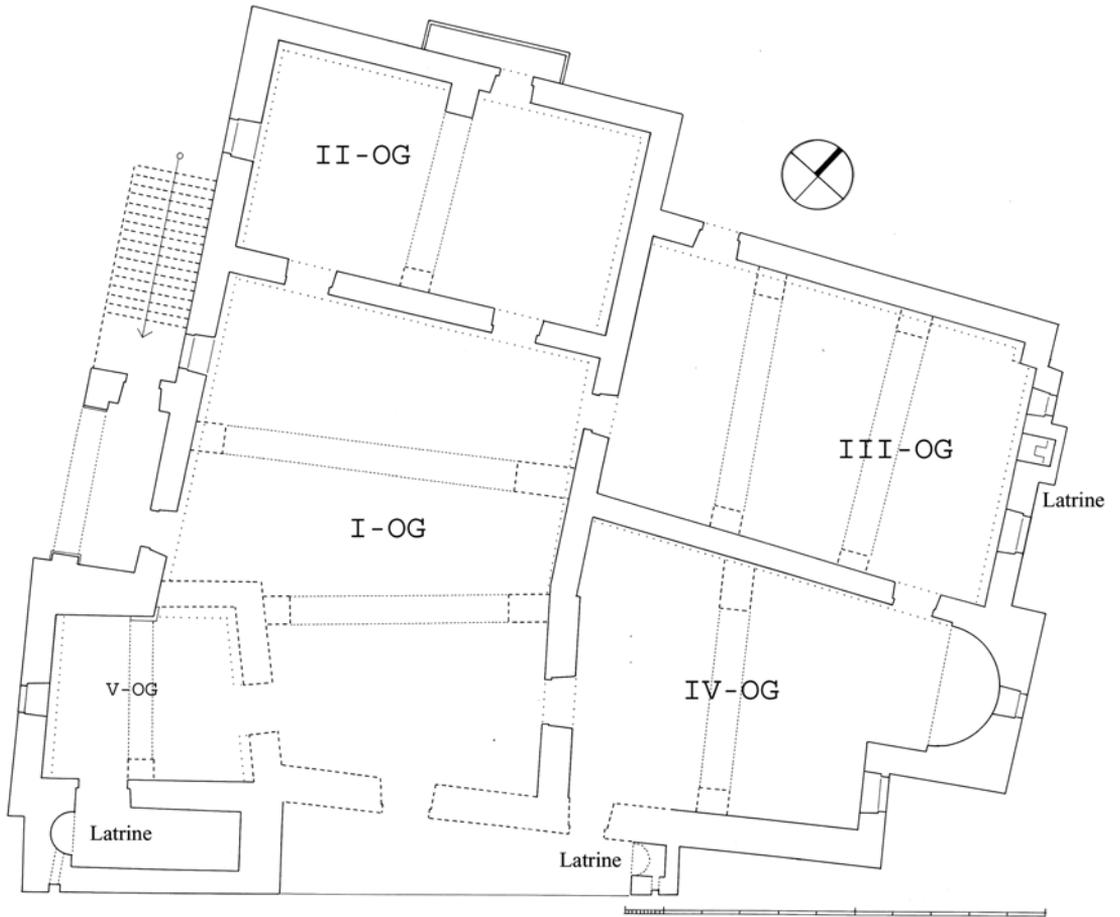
Sinikkale. Grundriss des Obergeschosses, M 1: 200.
